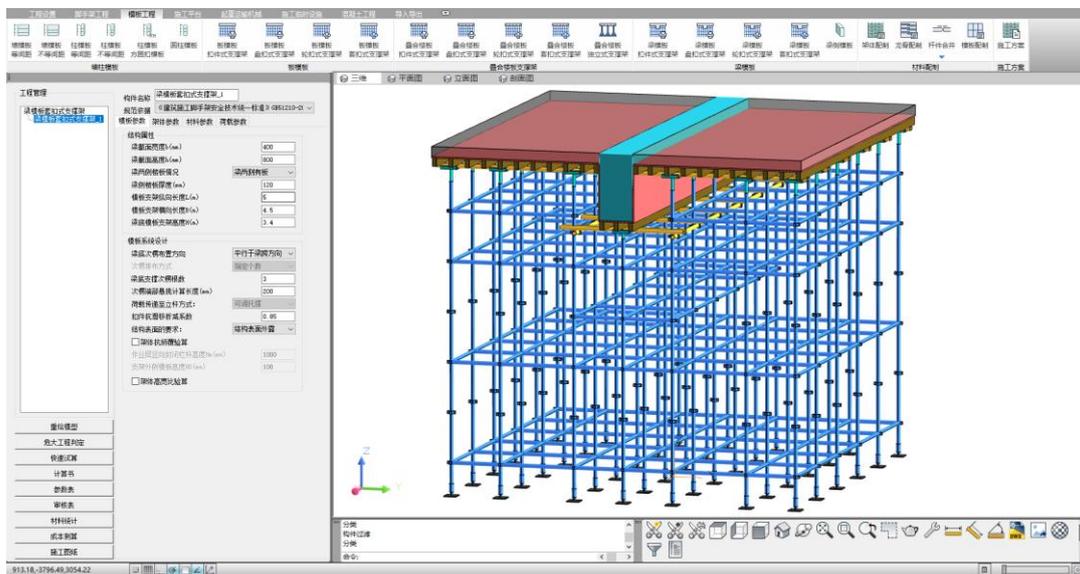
梁模板-轮扣式支撑架架体平面图
